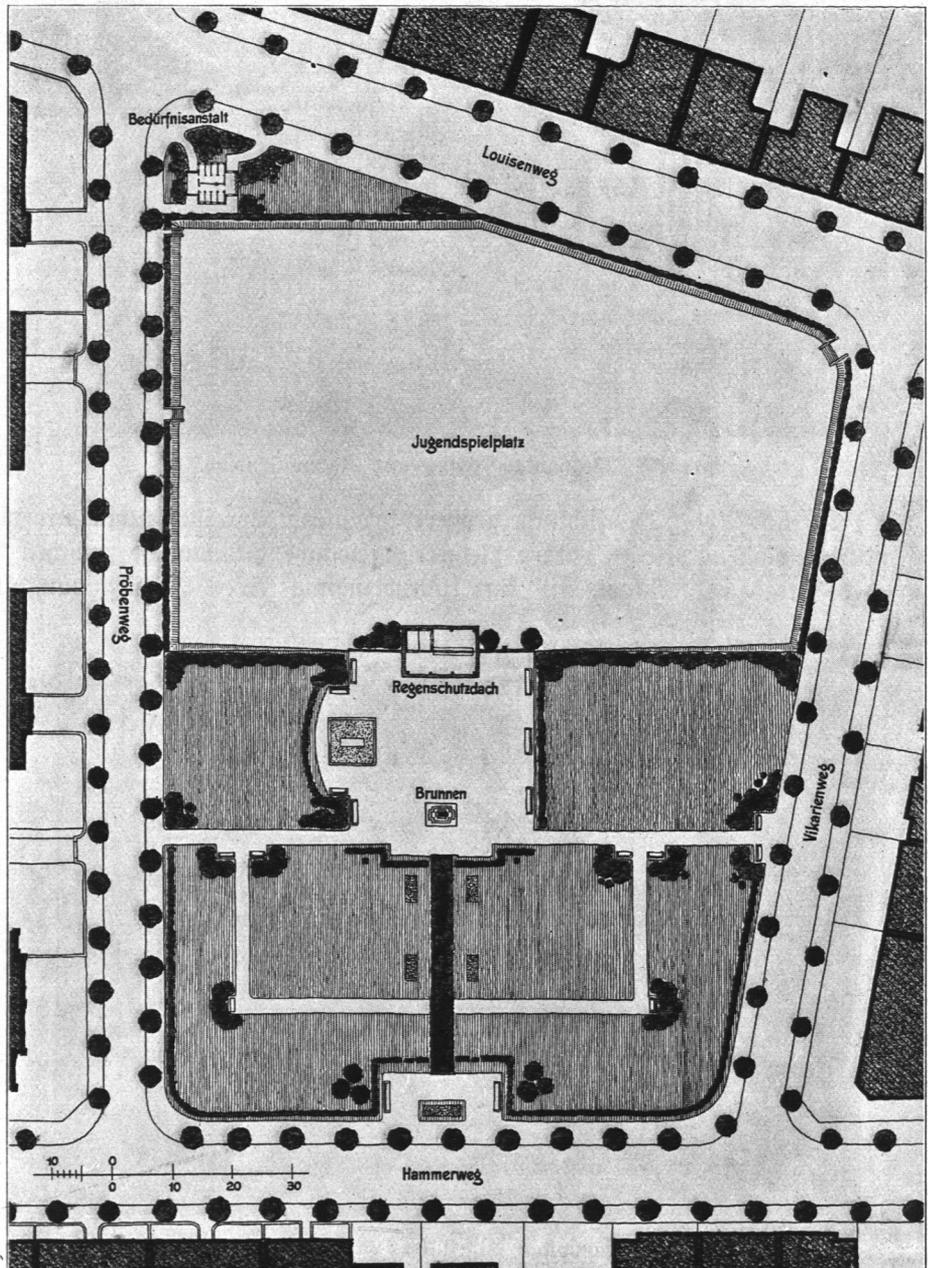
Grünanlage Luitjenweg, Lageplan.
